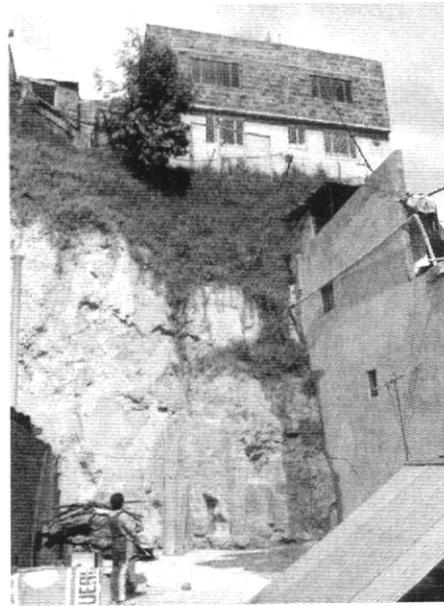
Vista del colapso de la cubierta compuesta por tejas plásticas soportadas por una estructura metálica, de la parte posterior de la vivienda de la Calle 51 Sur # 11-04
